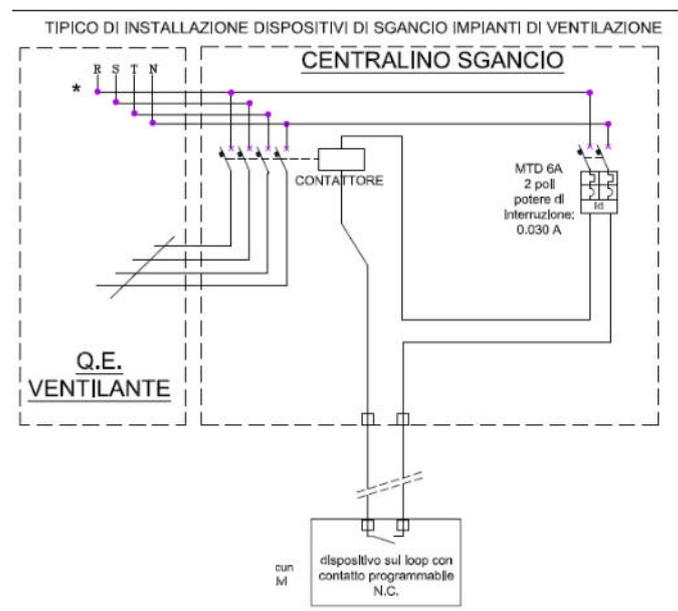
Schema di collegamento dispositivo di sgancio impianto di ventilazione
